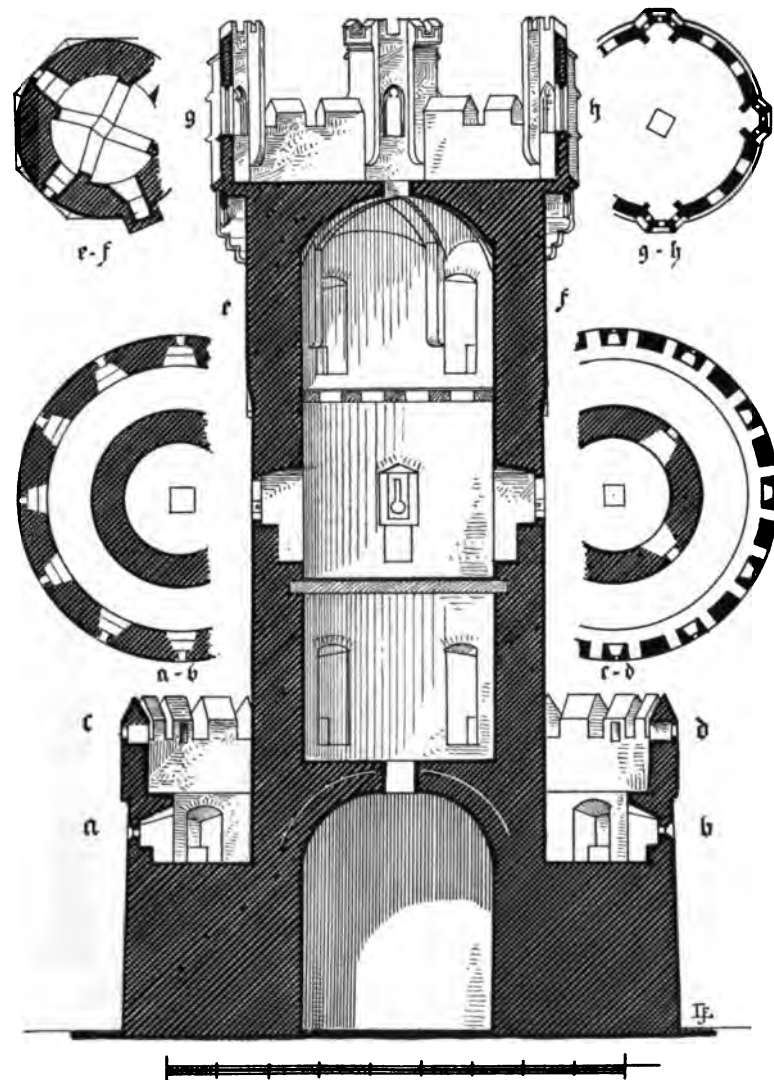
Rüdesheim. Adlerturm. (Nach v. Cohausen.) Durchschnitt und Grundrisse.
